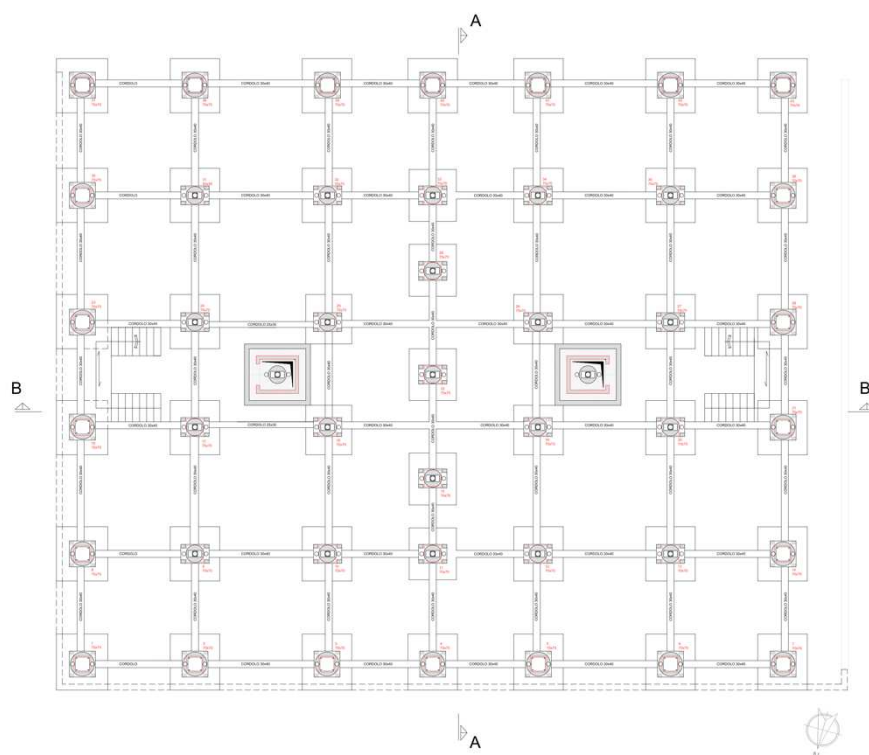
Carpenteria dell'edificio nello stato di progetto. Pianta fondazione (scala 1:50).
